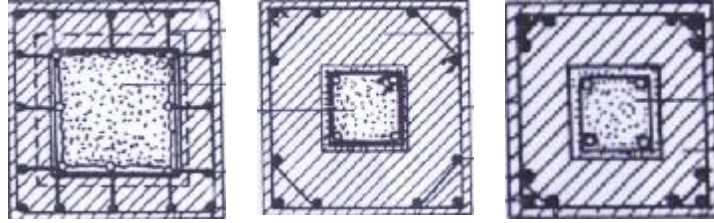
Ferrailage de la gaine :disposition nconstructives
